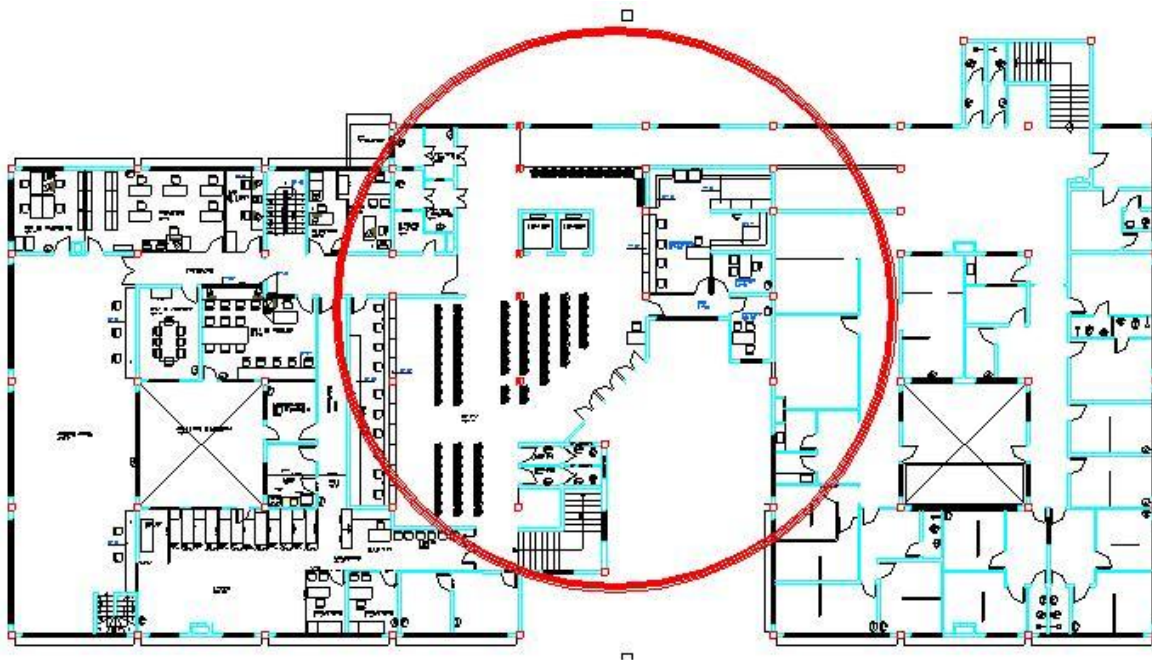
Planta baixa do pavimento térreo do atendimento ambulatorial, área de pesquisa. Fonte: Cedido pelo HUPES
